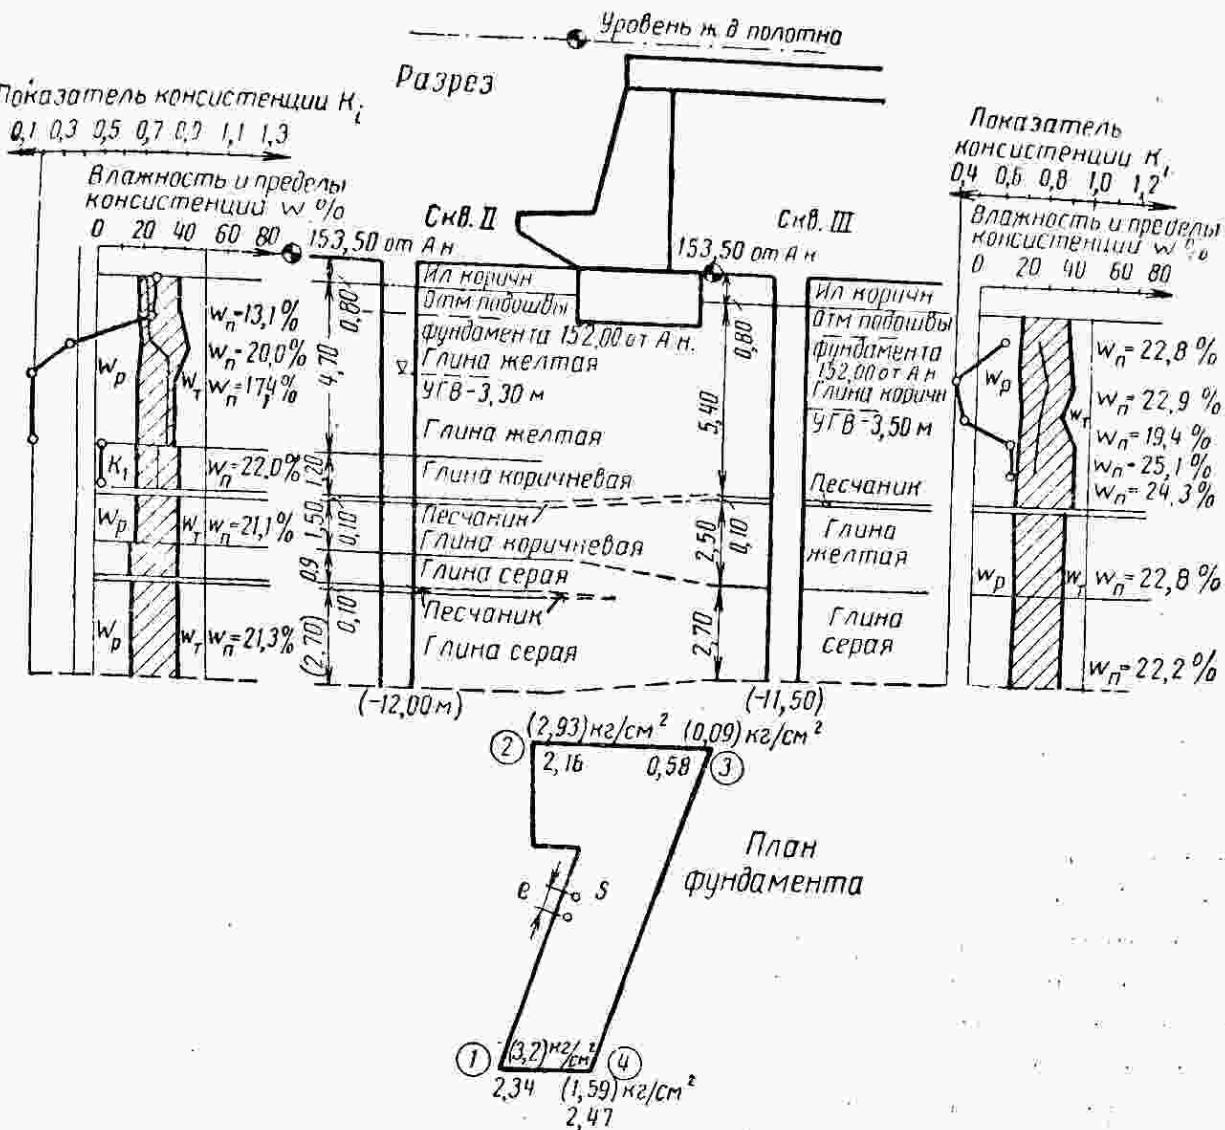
Схема фундирования железнодорожного путепровода в Вацуйфалу
